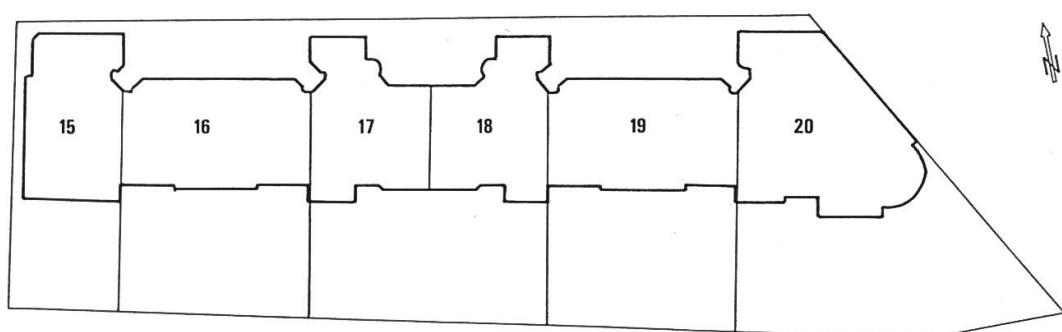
Falkenhöheweg 15a–20 von 1894/1895 in der Längsgasse. Gesamtgrundriss.
